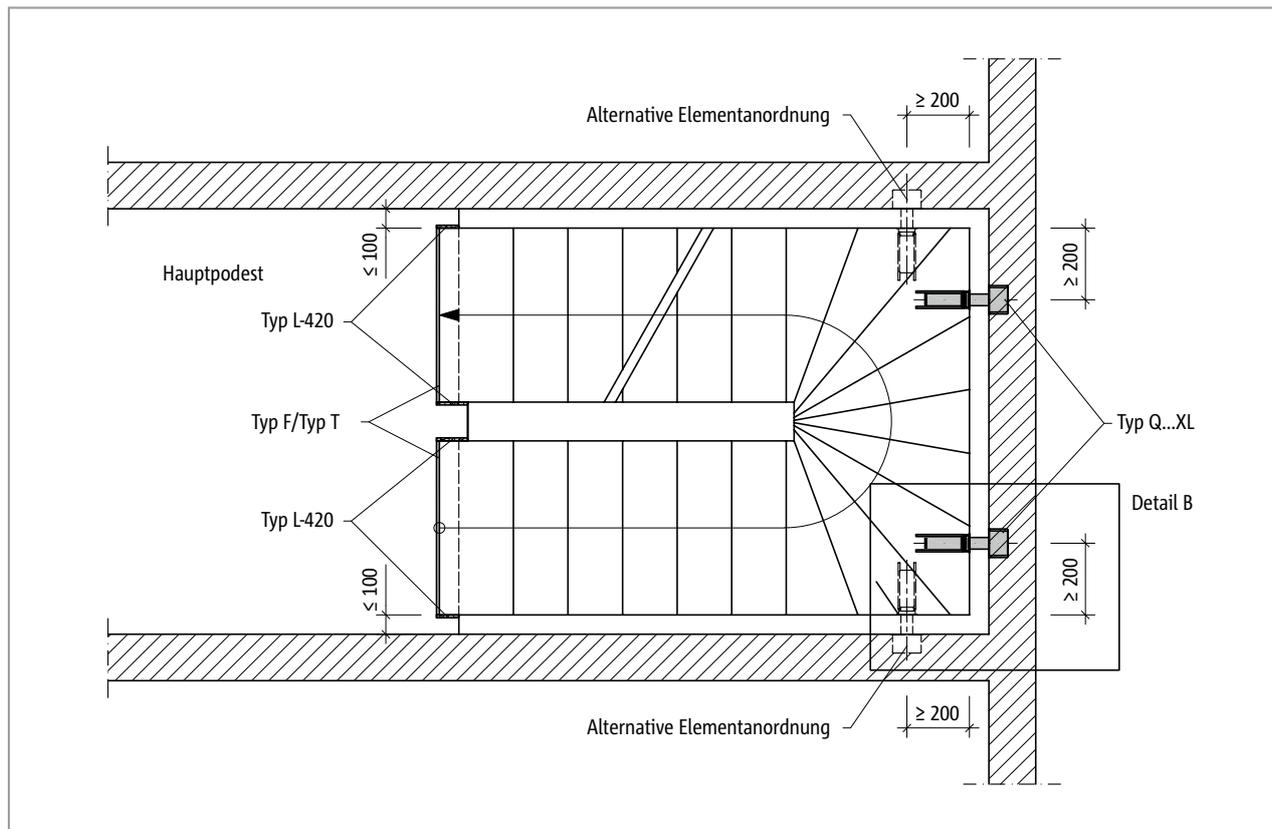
Schöck Tronsole® Typ Q...XL: Elementanordnung im Grundriss bei einer Fugenbreite von maximal 100 mm
